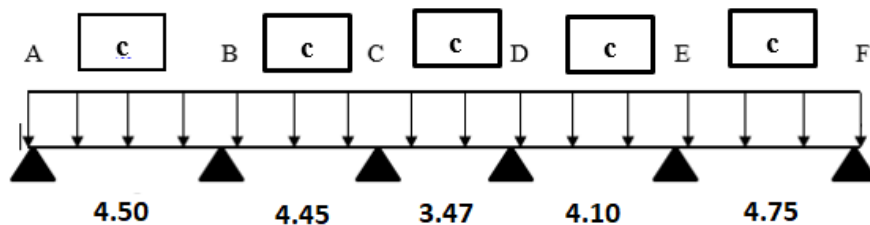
La poutre plancher étage courant sur 6 appuis toutes les travées sont chargées.
